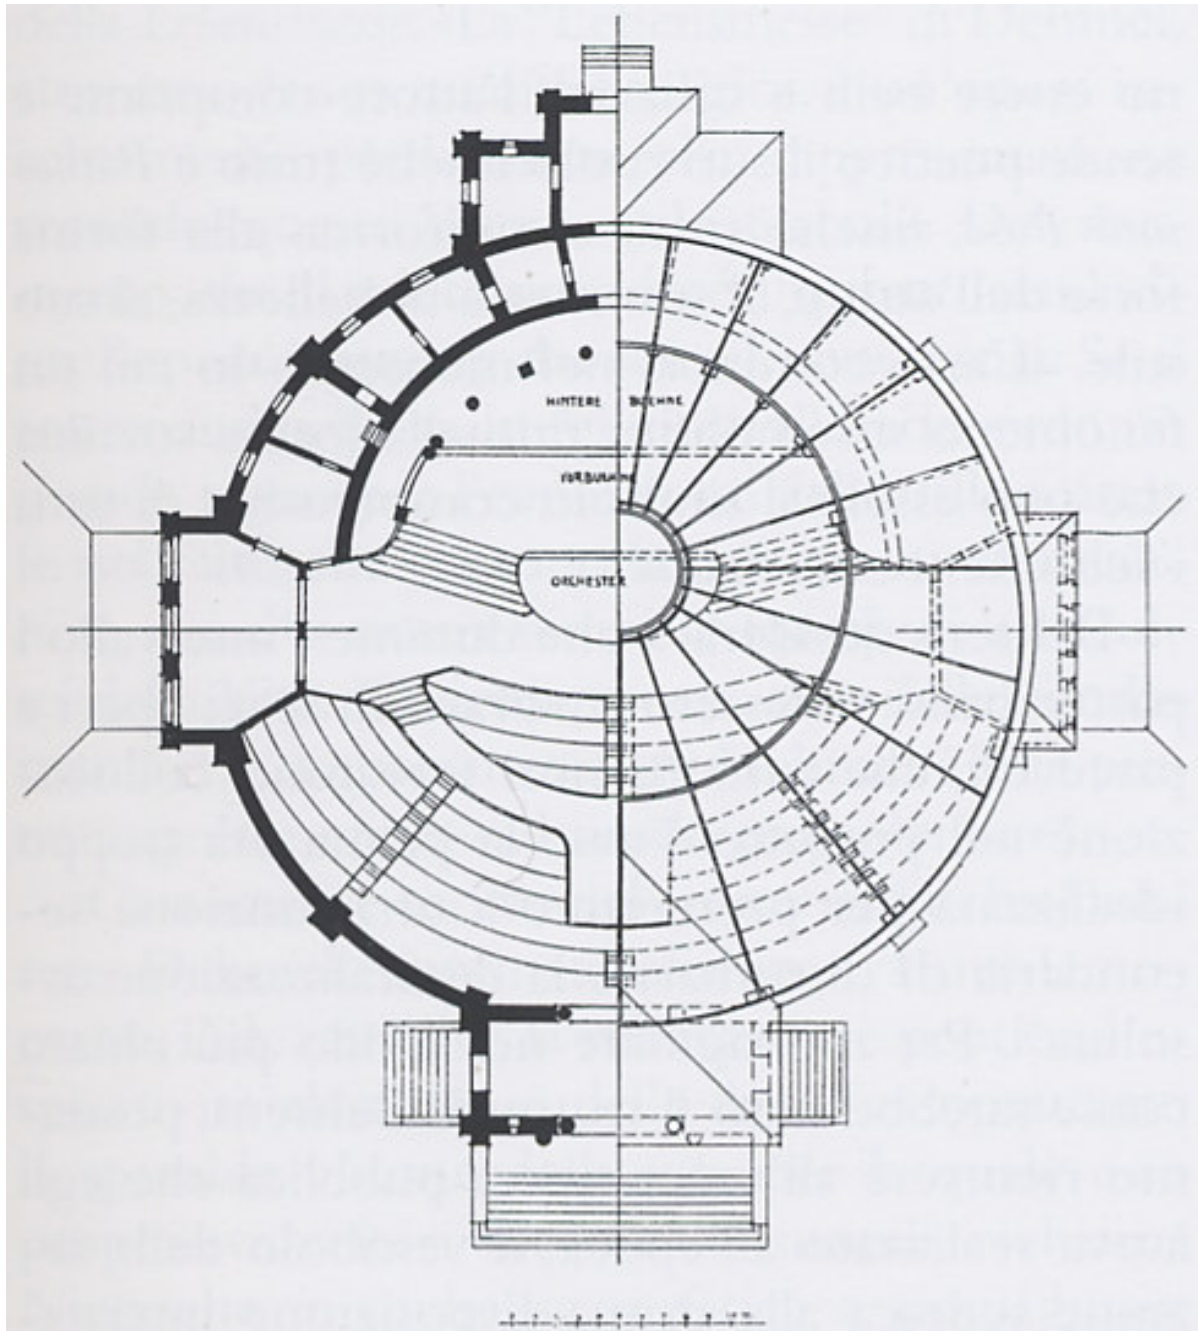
Peter Behrens, Pianta del Festspielhaus, 1900.
